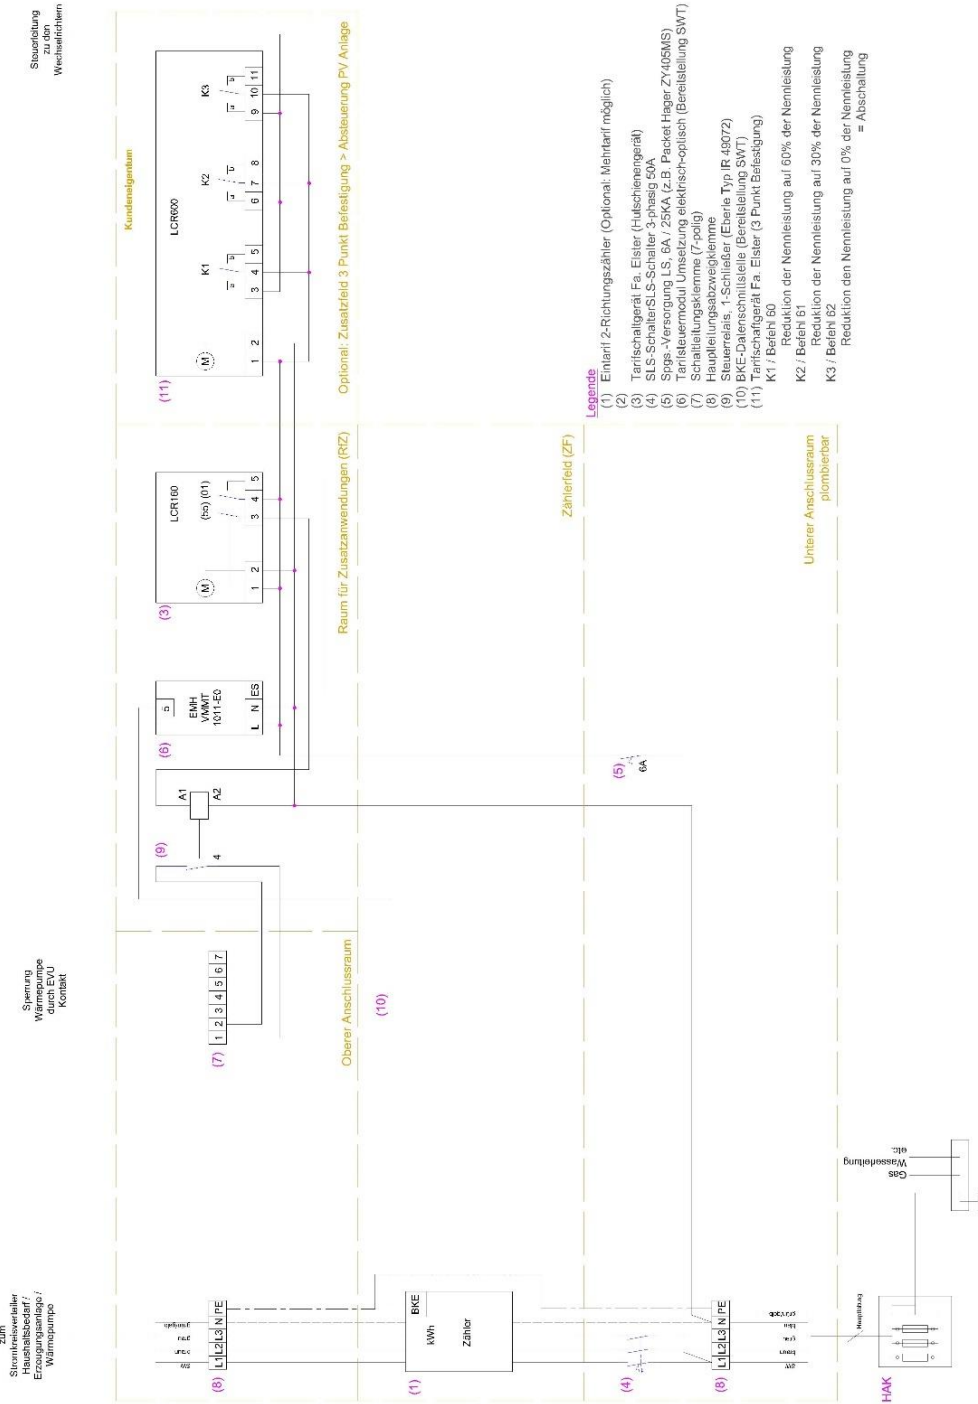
Standardverdrahtung Haushalt + Wärmepumpe + PV Anlage
